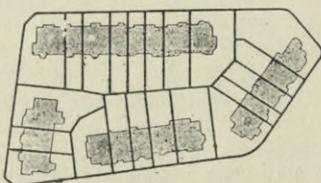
Halboffene Bauweise. Block zwischen Waldschlöbchen und König-Albert-Park in Dresden. 1:4000. Reihenhäuser mit Maximalängen und bestimmten Abständen
